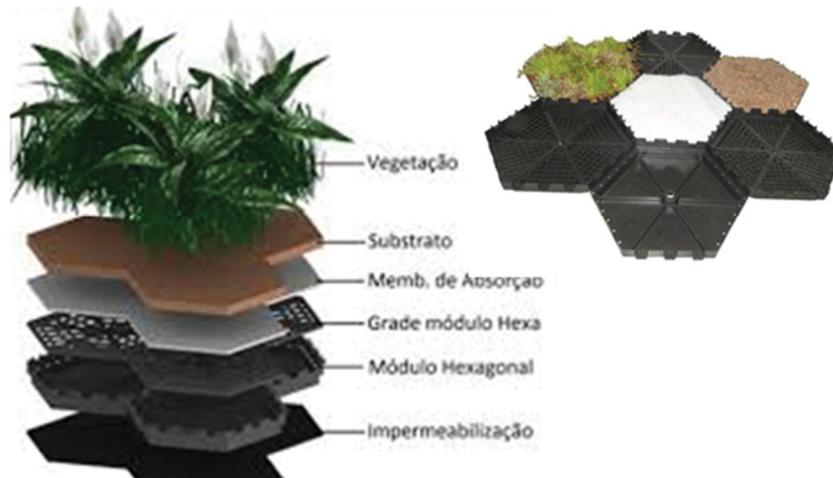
SISTEMA ALVEOLAR LEVE ECOTELHADO
